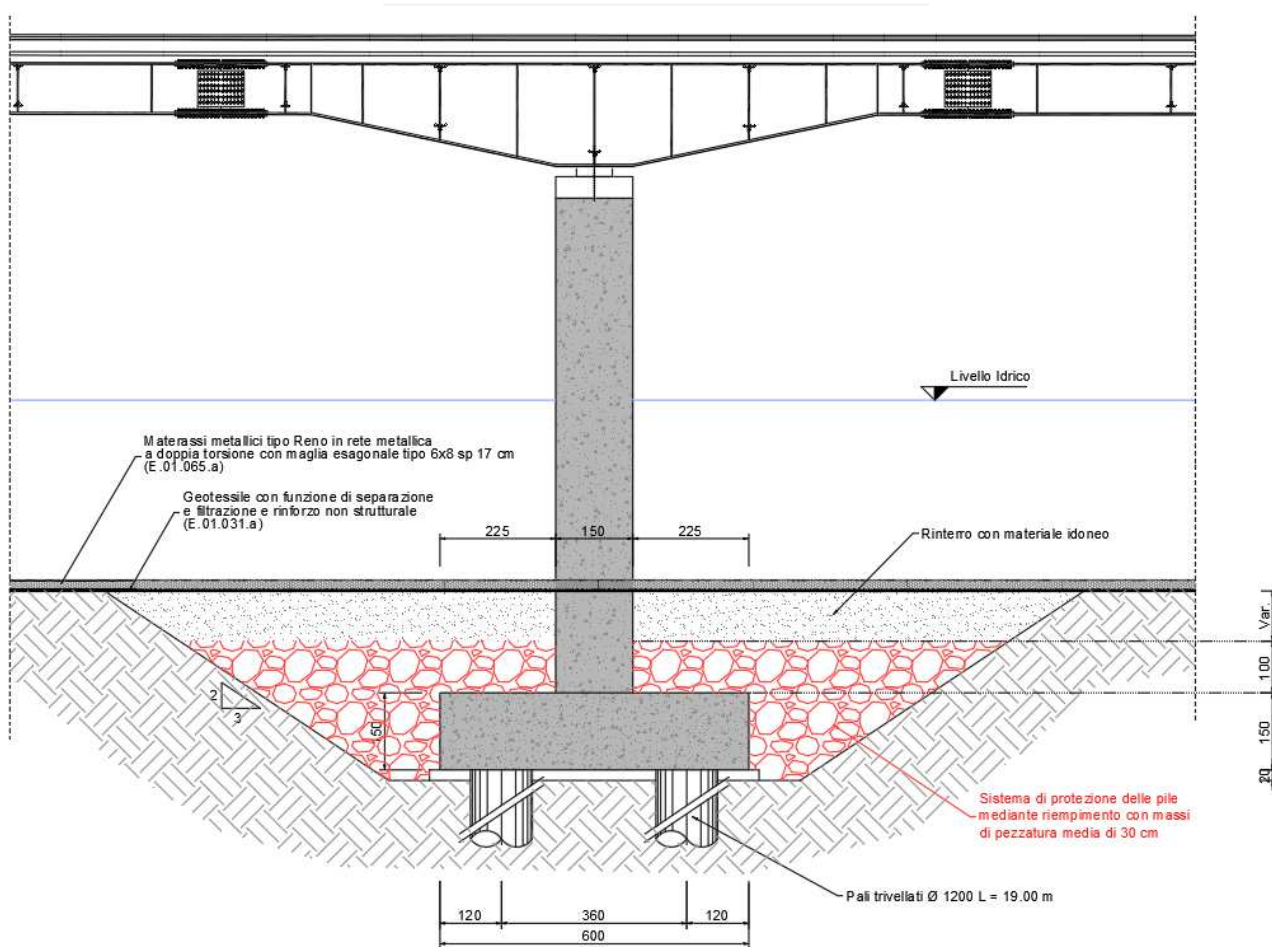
Sezione di posa della pila P1 e P2 del viadotto "VASCHE DI SPAGLIO - VI04" con l'inserimento delle opere di protezione.
